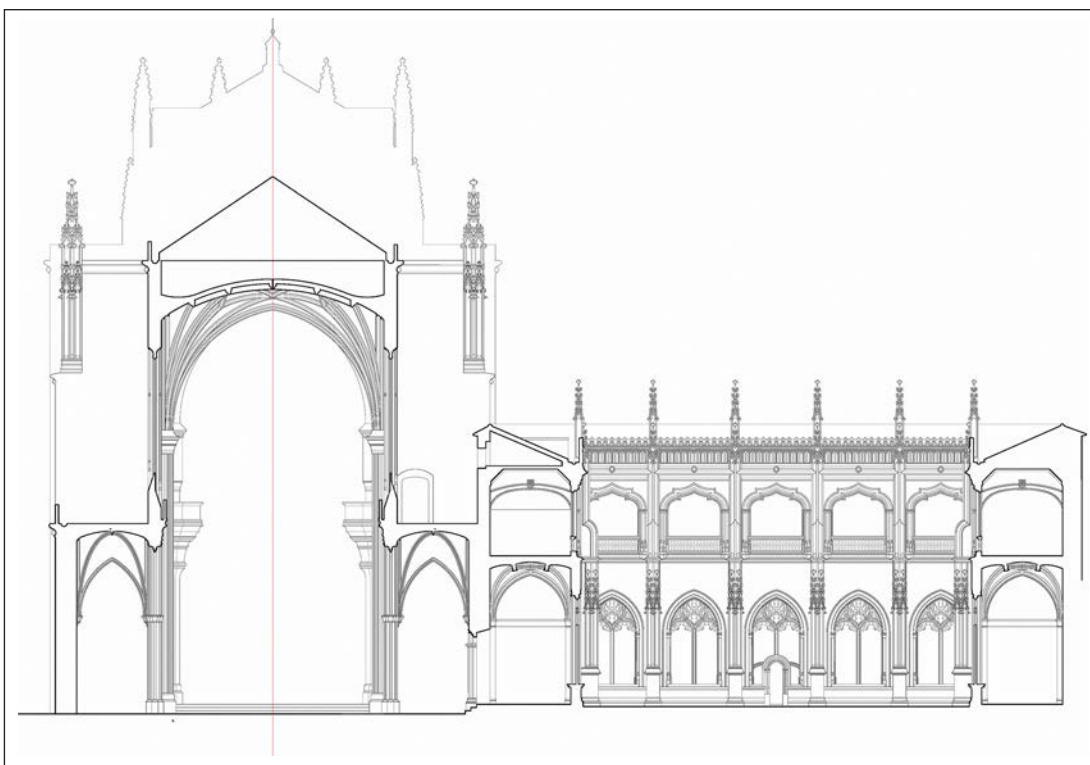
Sección transversal de la iglesia por la nave, mostrando el alzado del claustro en su frente norte (D.A.).
